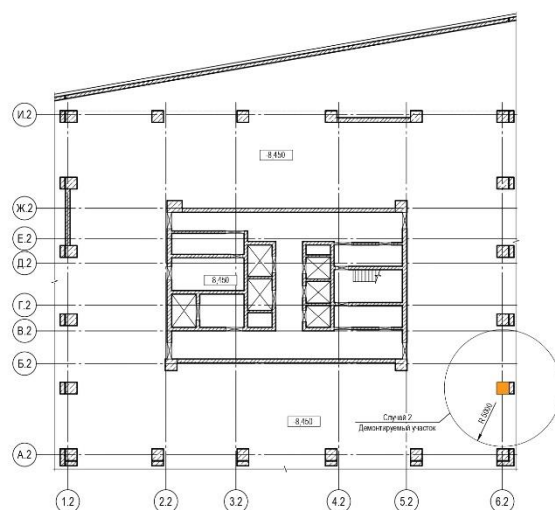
Корпус К-2. Схема аварийного случая 2
